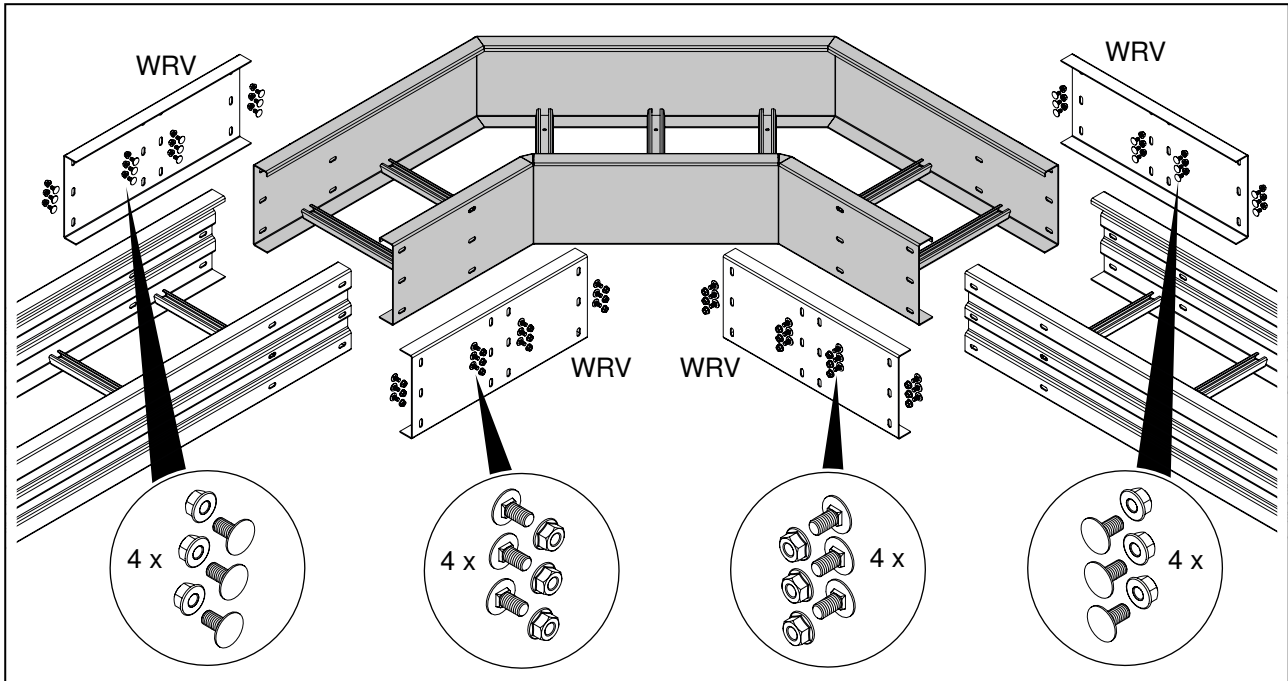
Bauteile für Montage Bogen 90° Seitenhöhe 160 mm
